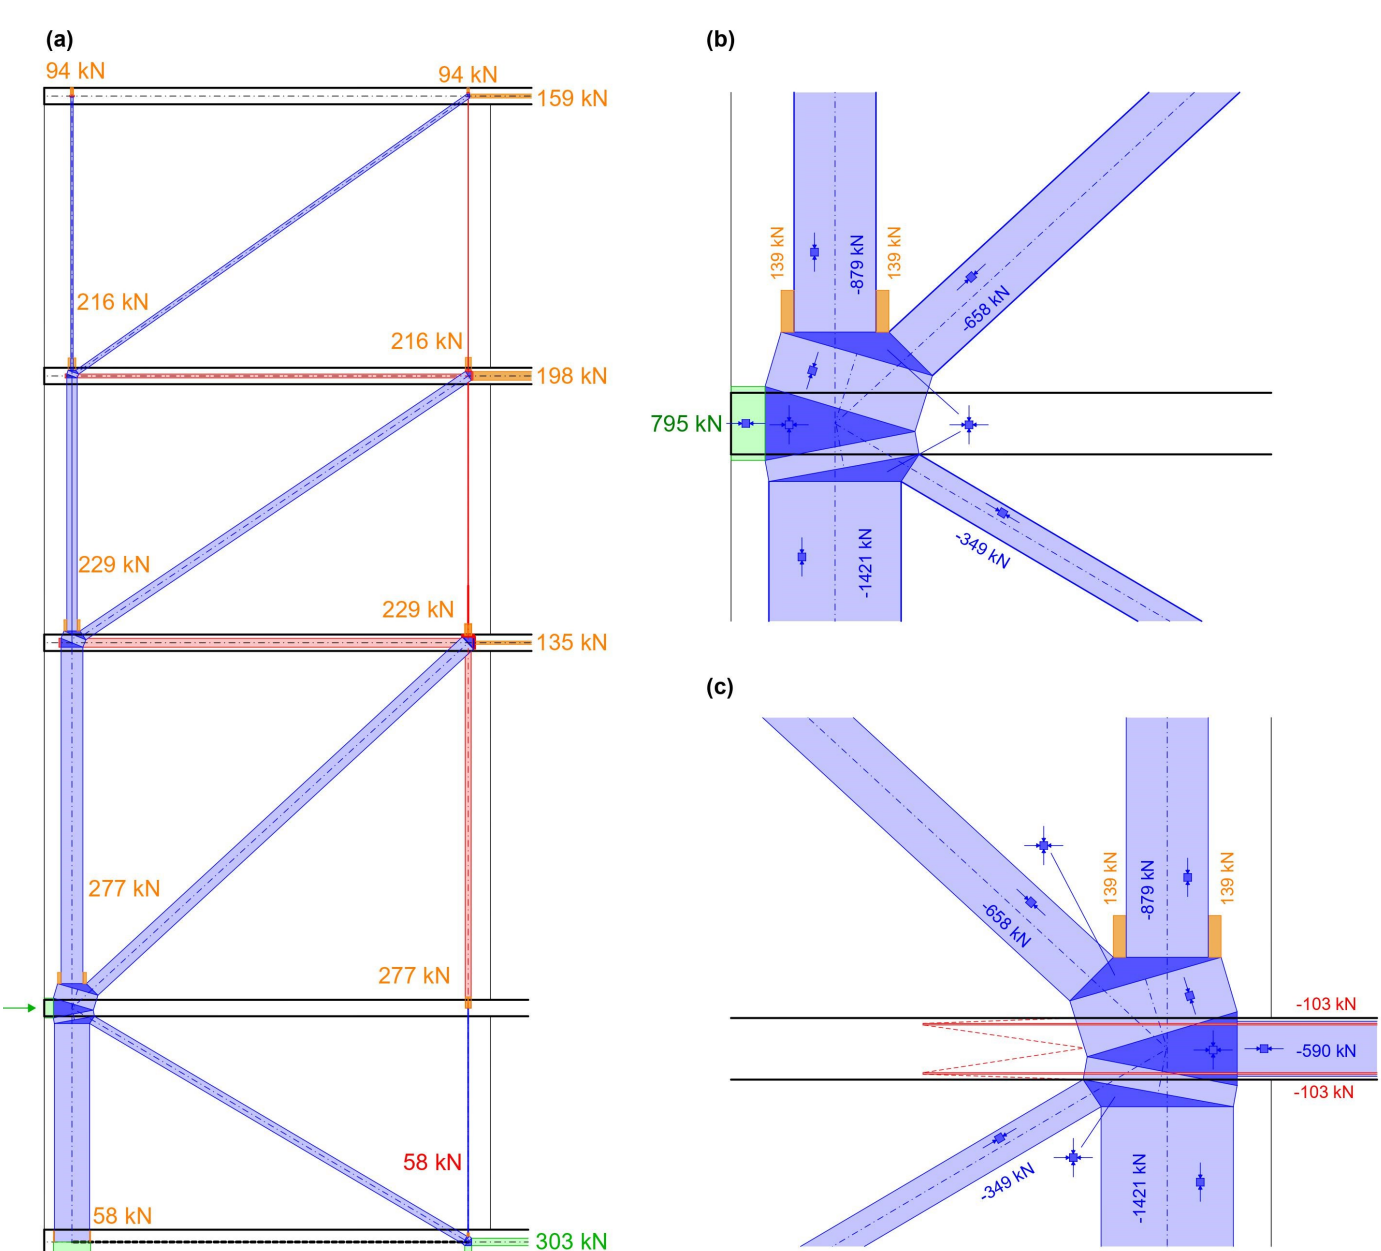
(a) Strebenmodell Tragwand, (b) Fachwerknoden Decke über UG (c) Alternativer Fachwerknoden mit Druckbewehrung (Eigene Darstellung)
